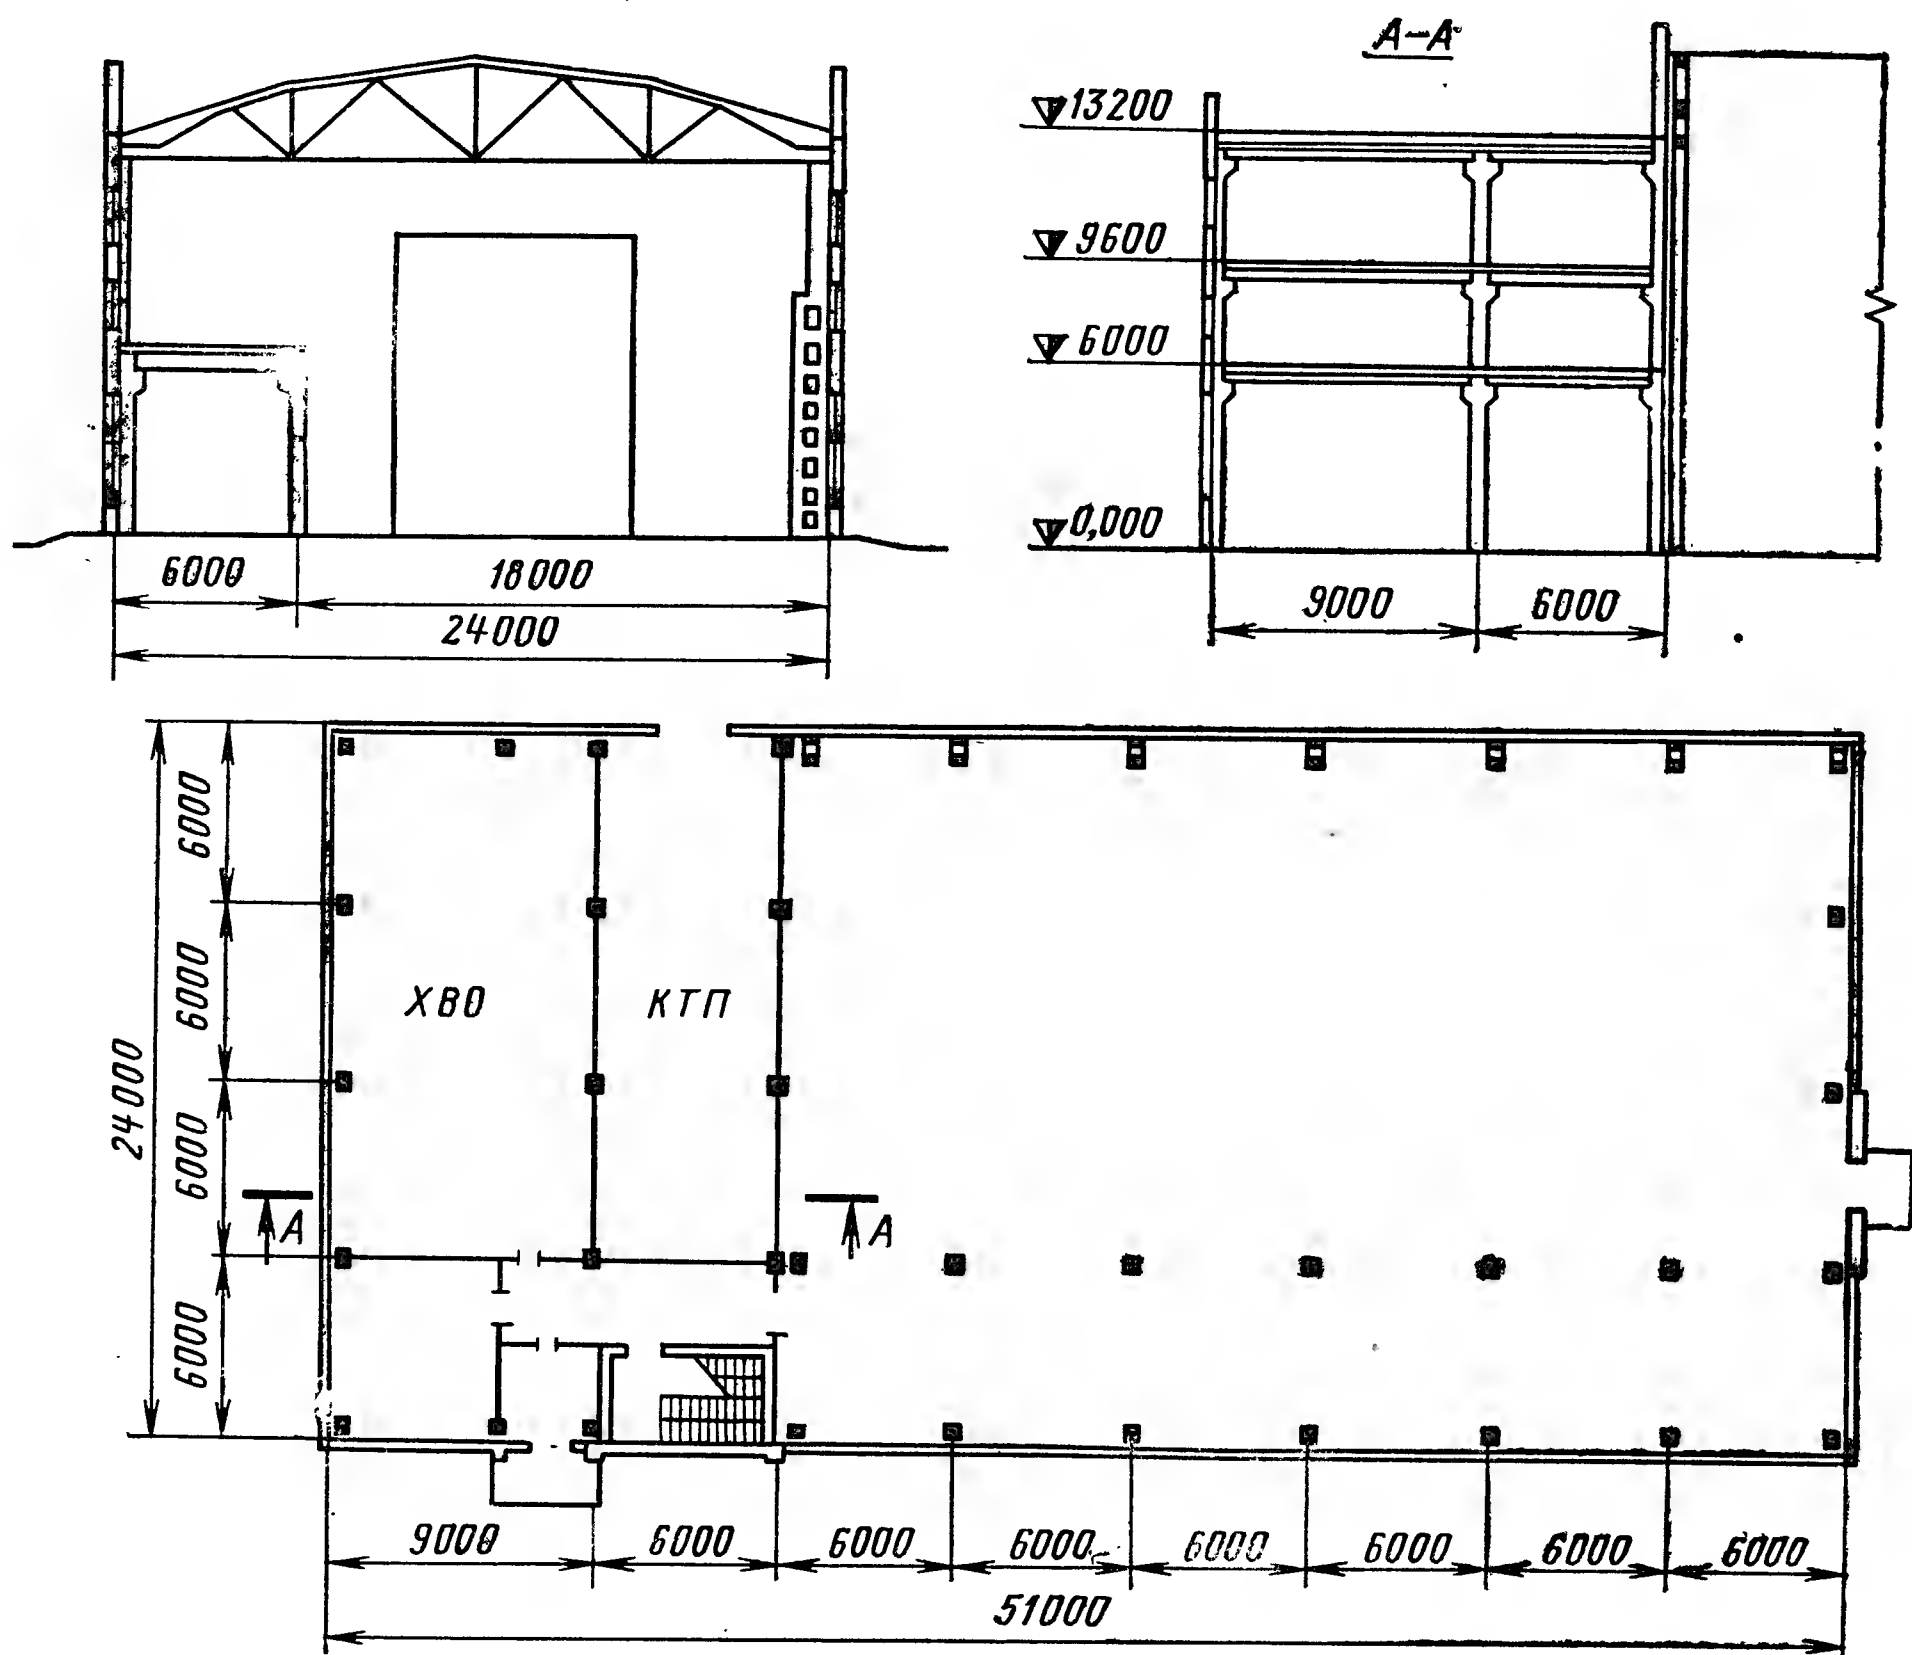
Габариты и схема здания котельной на 105 МВт (90 Гкал/ч) со стальными водогрейными котлами для газа и мазута (проект Латгипропрома).
